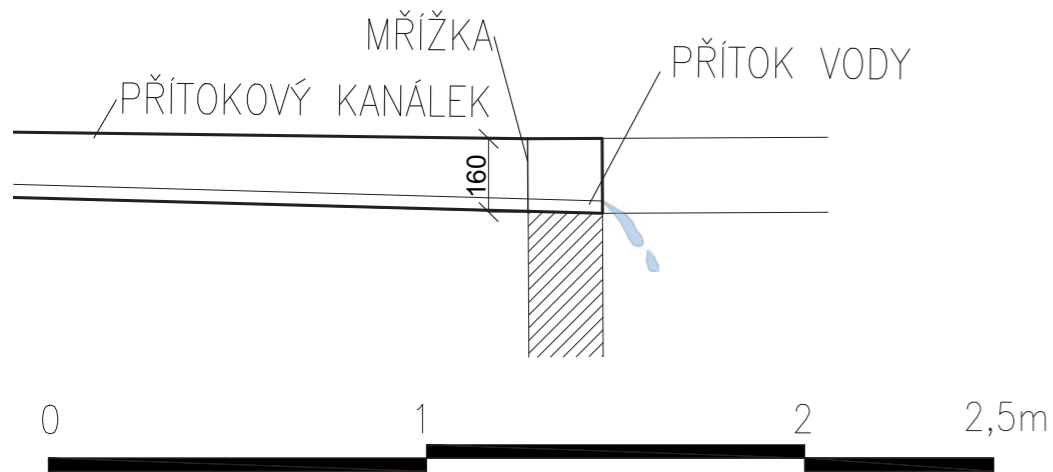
DETAIL B, ODTOKOVÝ KANÁLEK M 1:20
